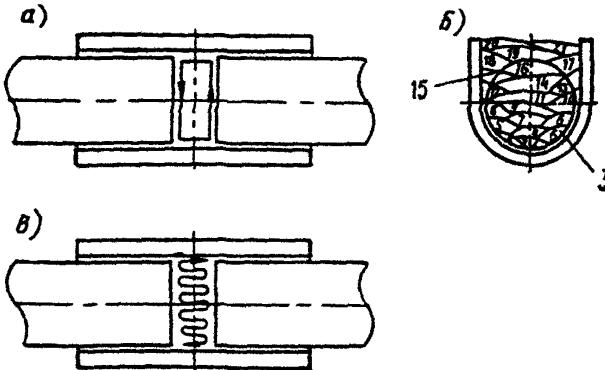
Техника механизированной сварки СОДП горизонтальных стержней
